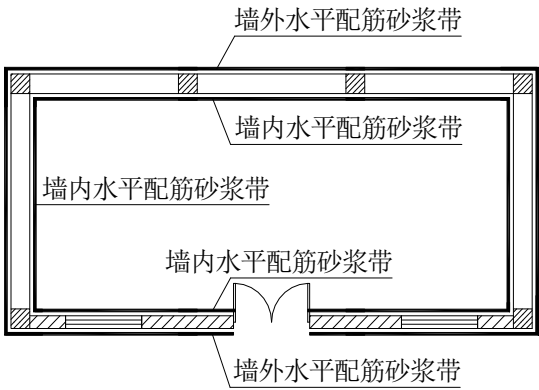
三间房水平配筋砂浆带布置平面示意图
